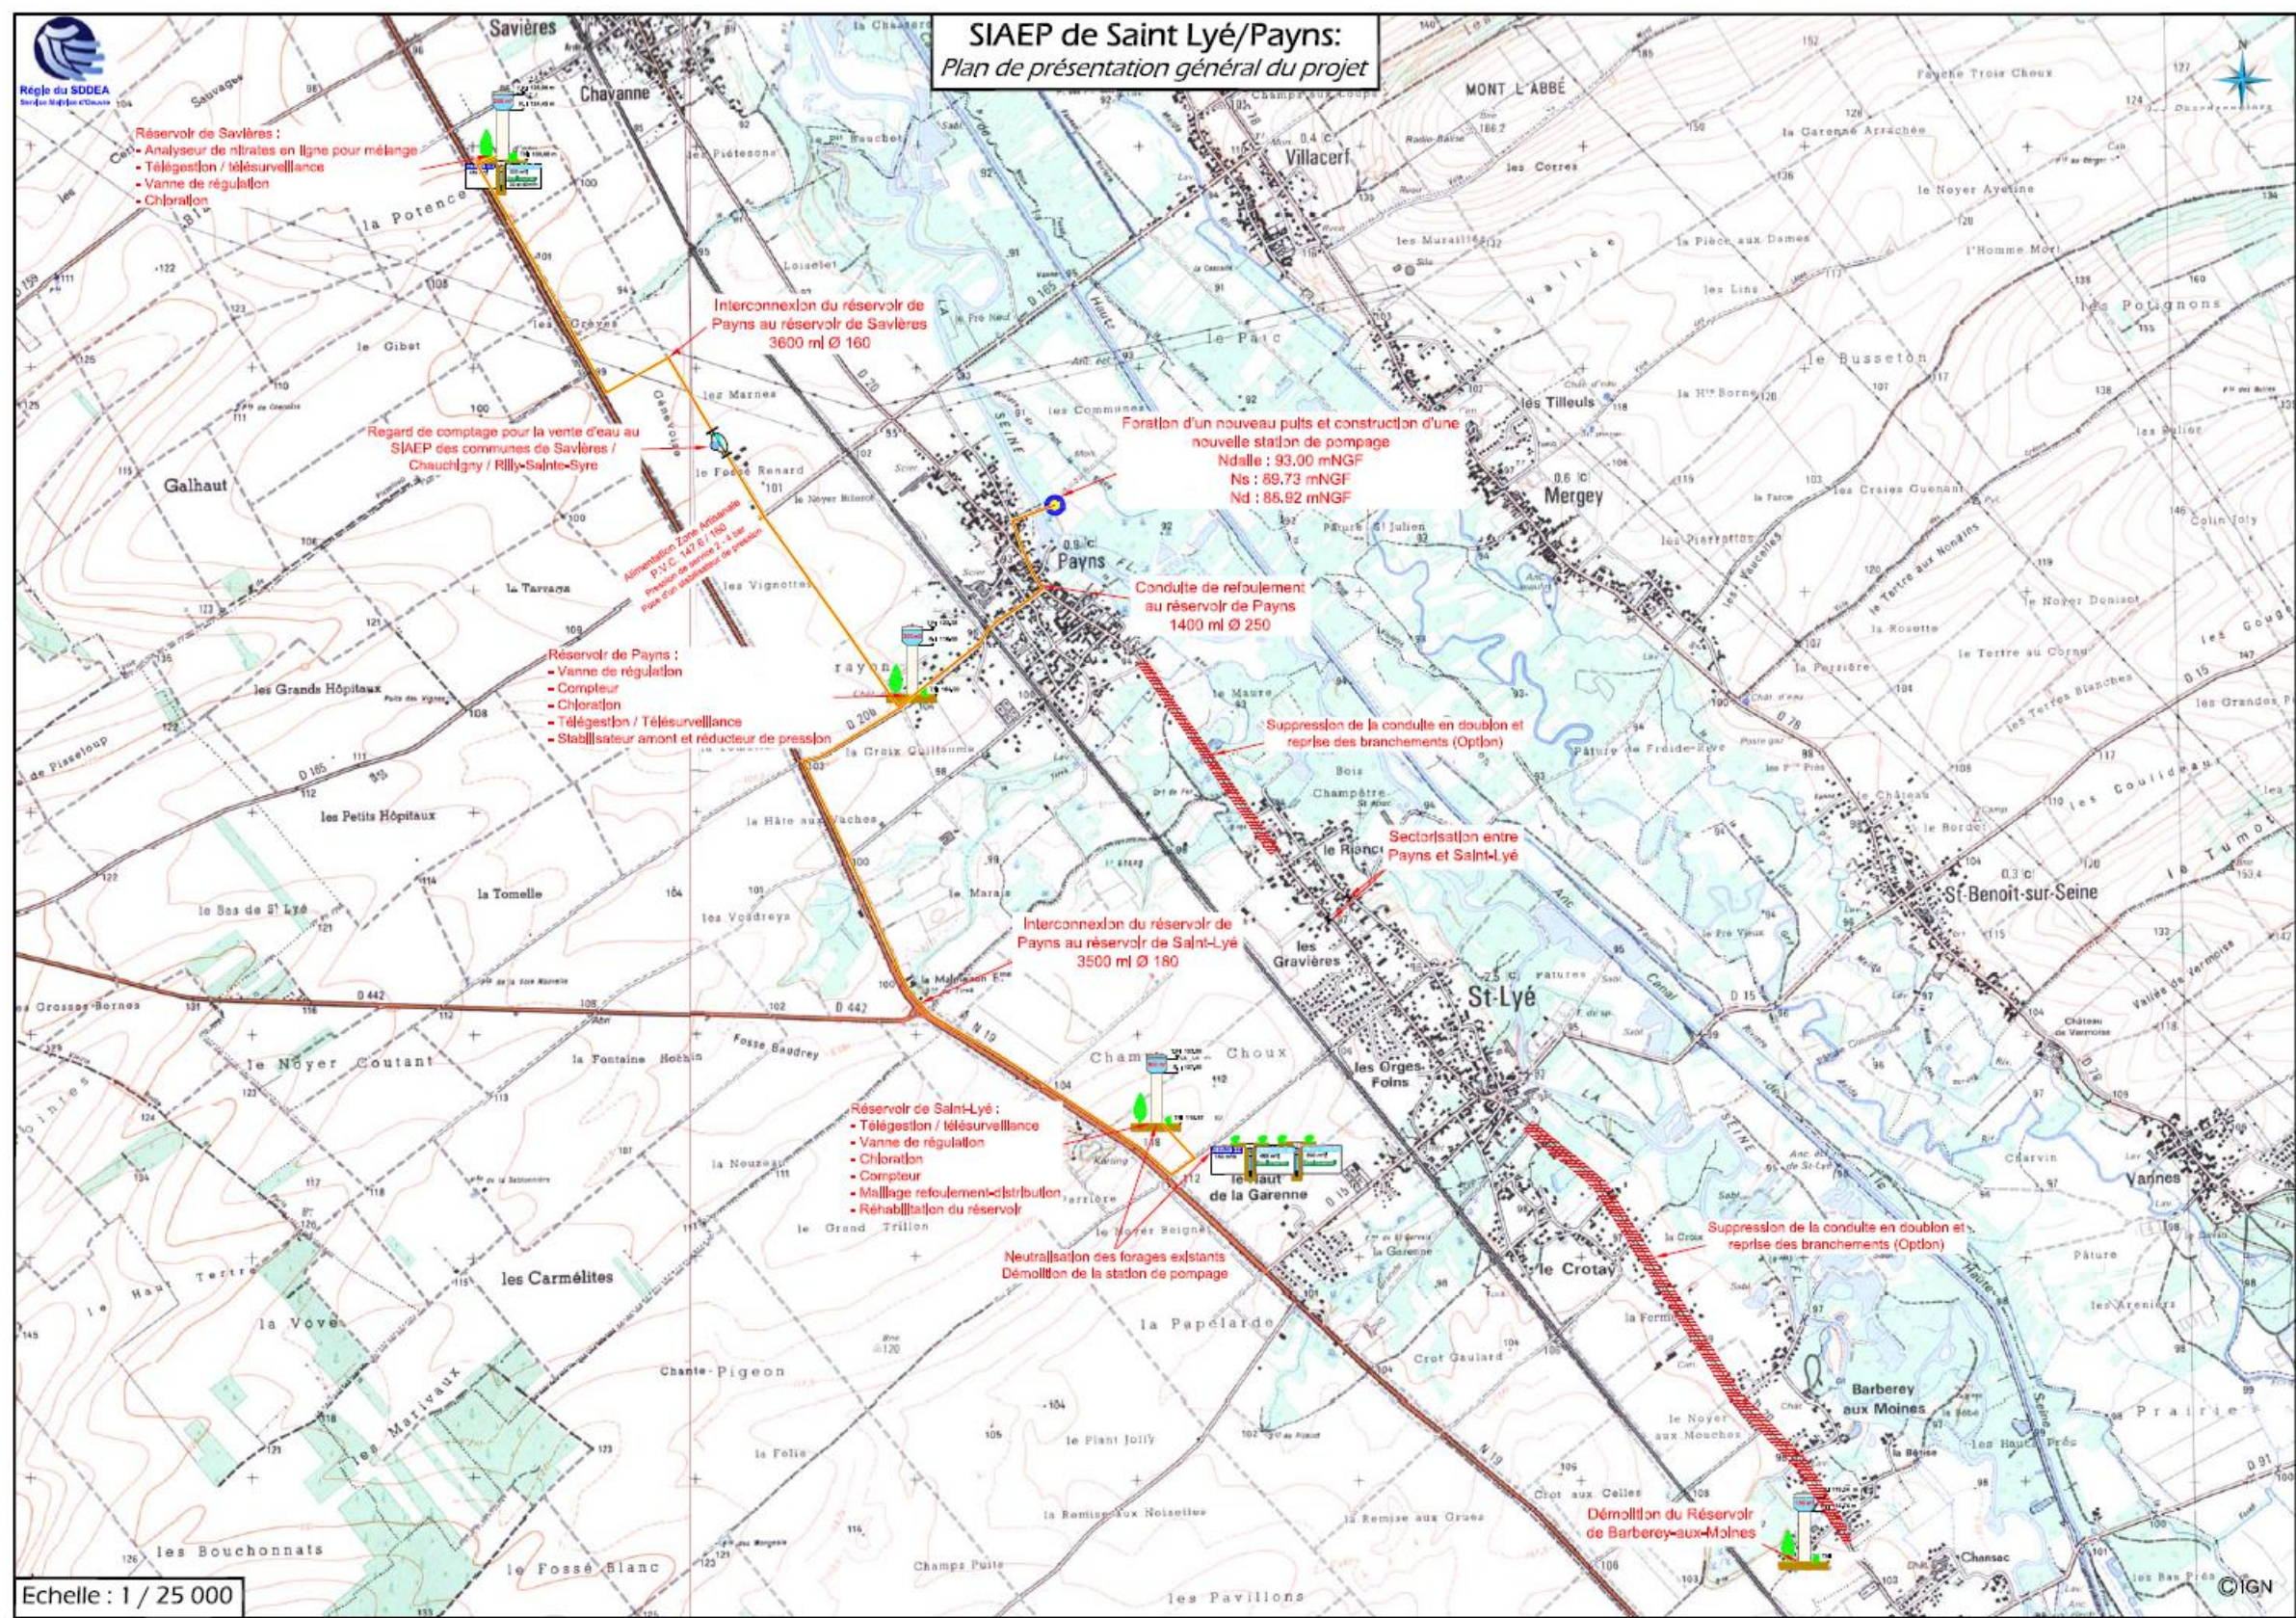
SCHEMA D'IMPLANTATION DU PROJET DE SAINT-LYE/PAYNS/SAVIERES (SOURCE : SDDEA)
